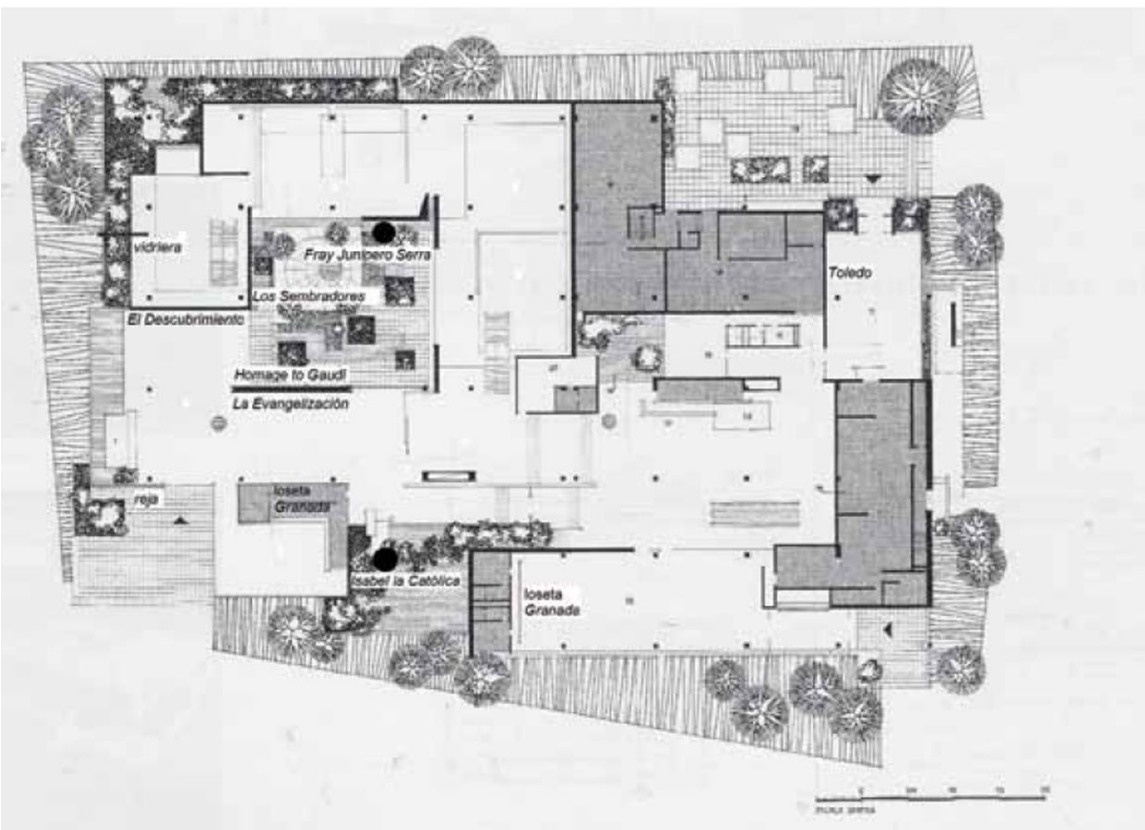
Sala de exposiciones en la primera planta del Pabellón.
